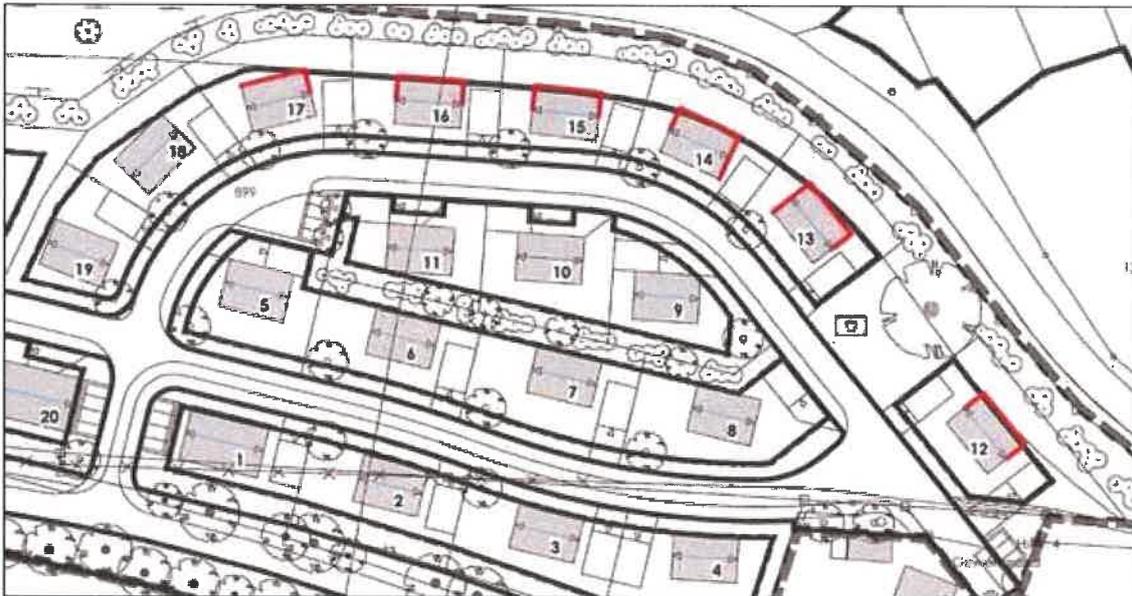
Lageplan mit Kennzeichnung der Fassaden, an denen Schallschutzmaßnahmen an schutzbedürftigen Außenwohnbereichen erforderlich sind (Maßstab 1:1.500)
